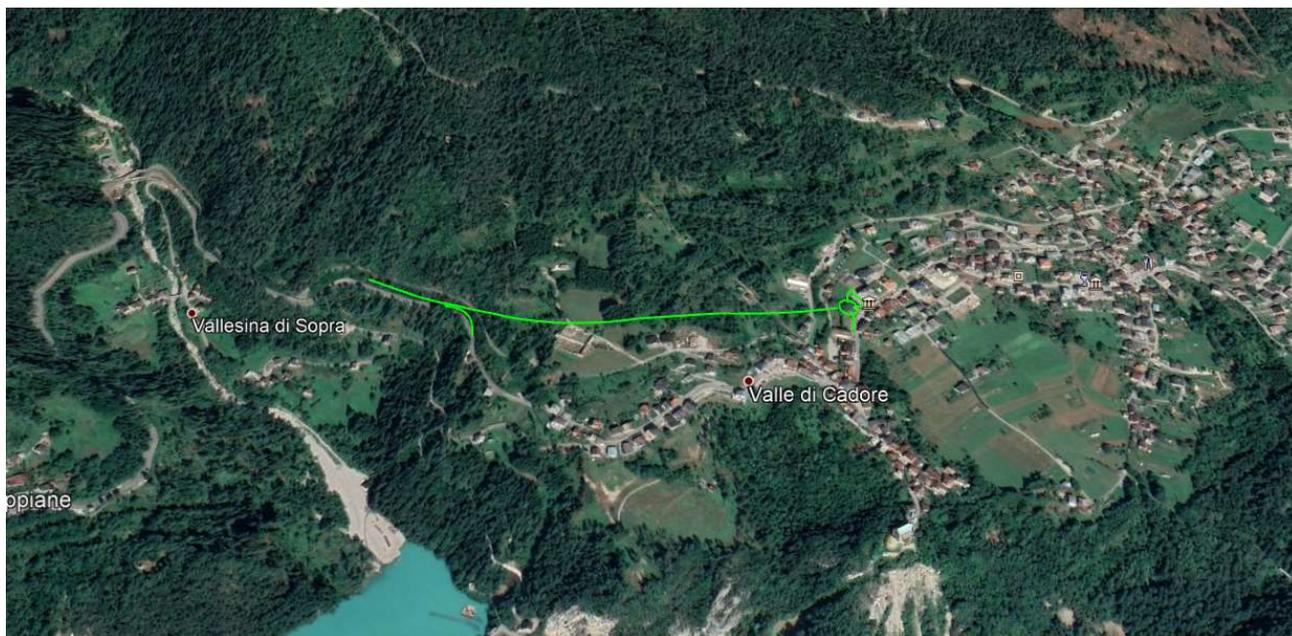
Ubicazione del tracciato di progetto su vista Google Earth
